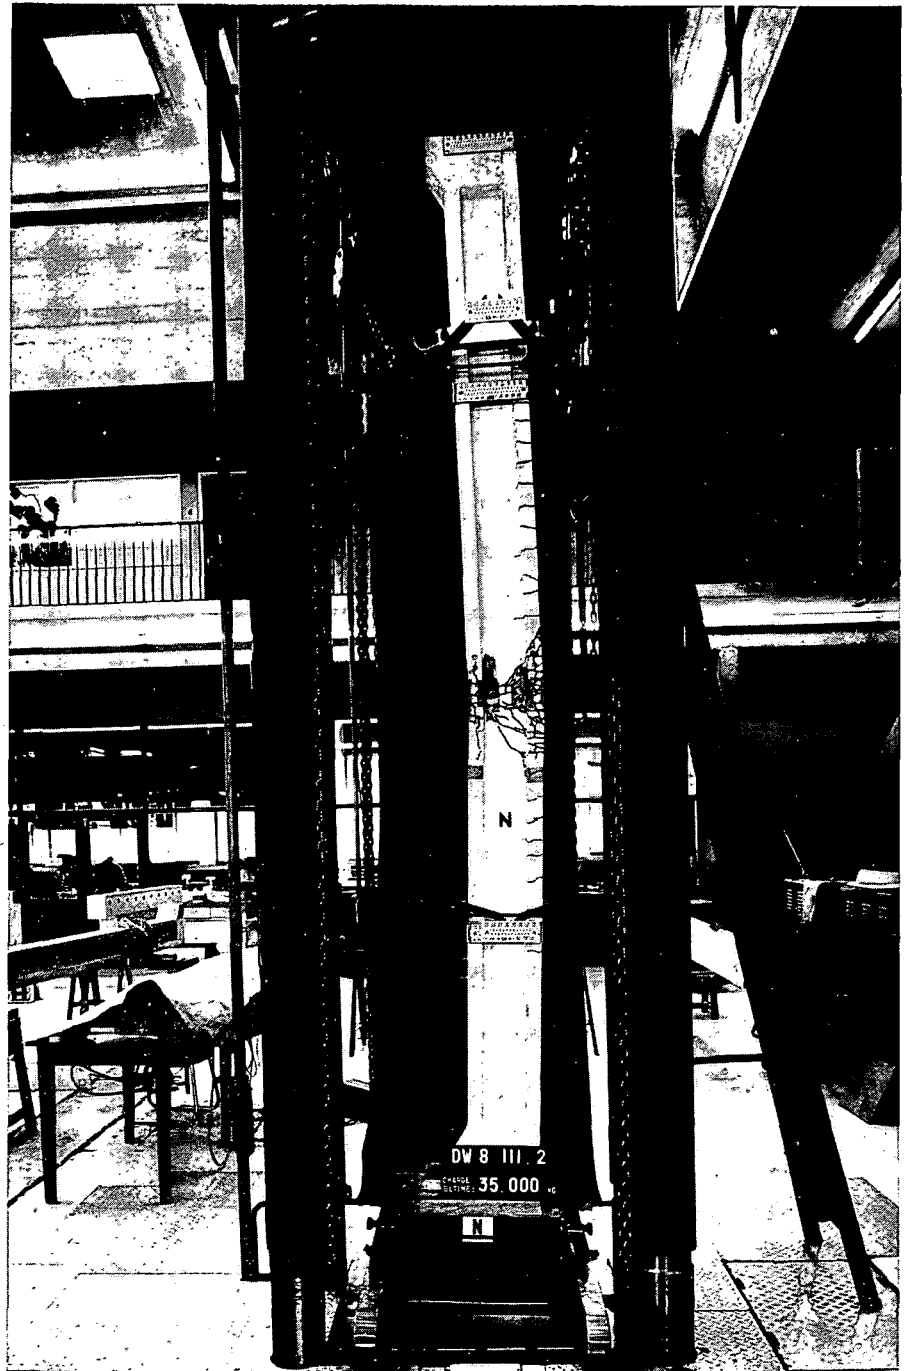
Flambement d'un poteau en béton armé de section en forme de H.
